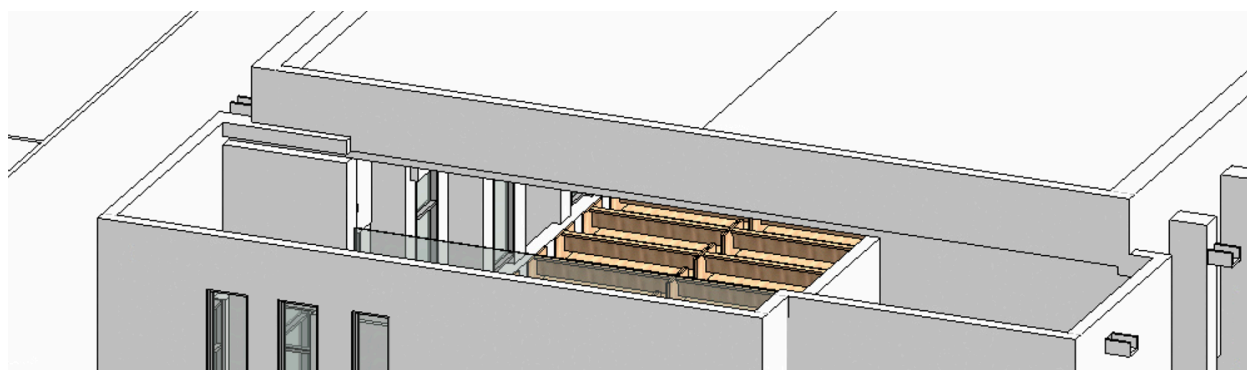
Cubierta arquitectónica de la Zona Entrada
